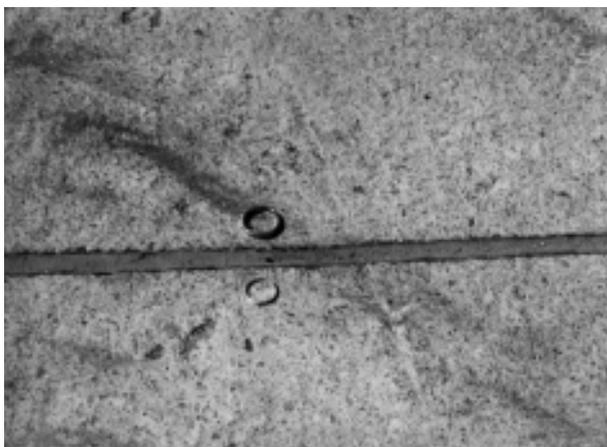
Junta transversal de construção *de emergência* já executada
